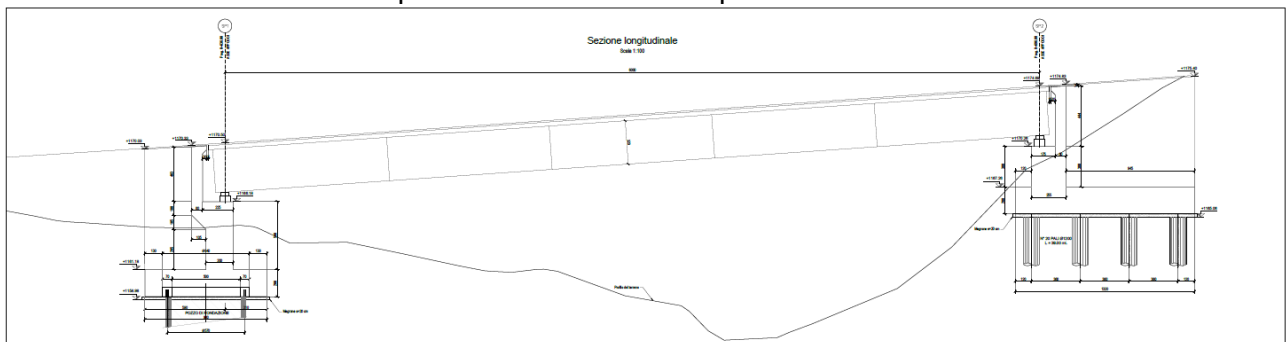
Ponte Bigontina – Sezione longitudinale
